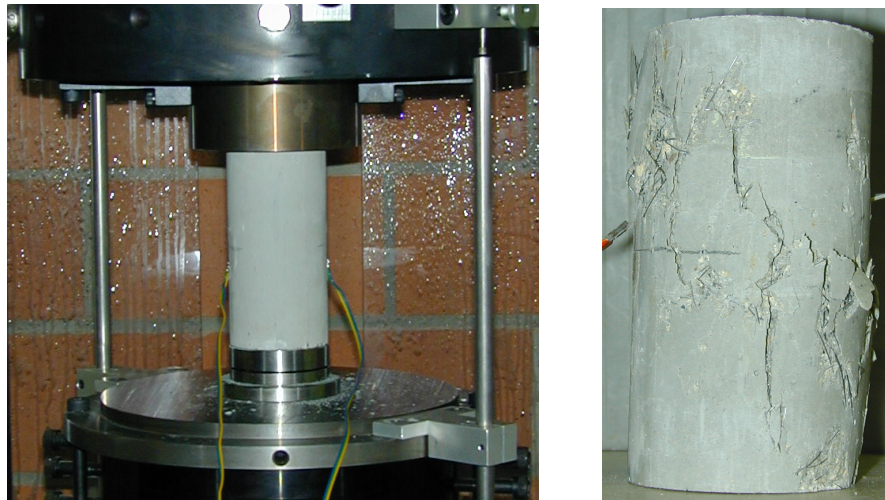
a,b: Versuchsaufbau und geprüfter Druckzylinder mit diagonaler Bruchfuge
